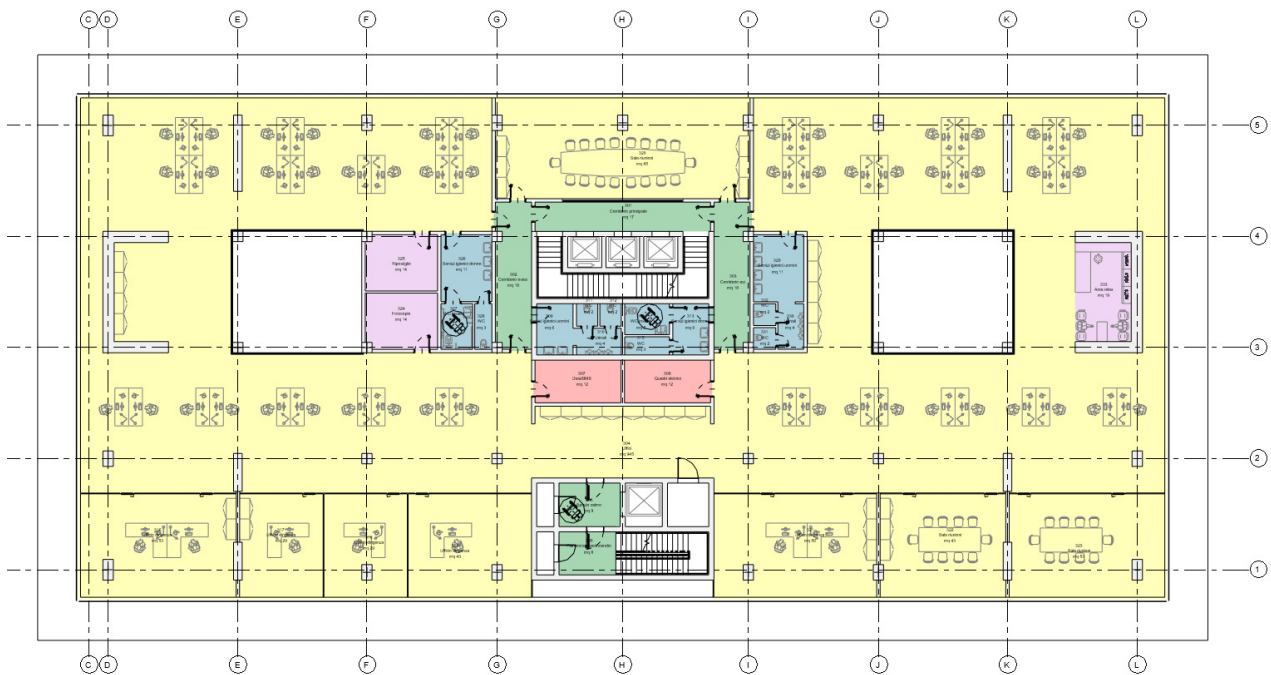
6ML8_P_G_E-ARC_4FA_003_07_000 - Pianta piano terzo - layout uffici
